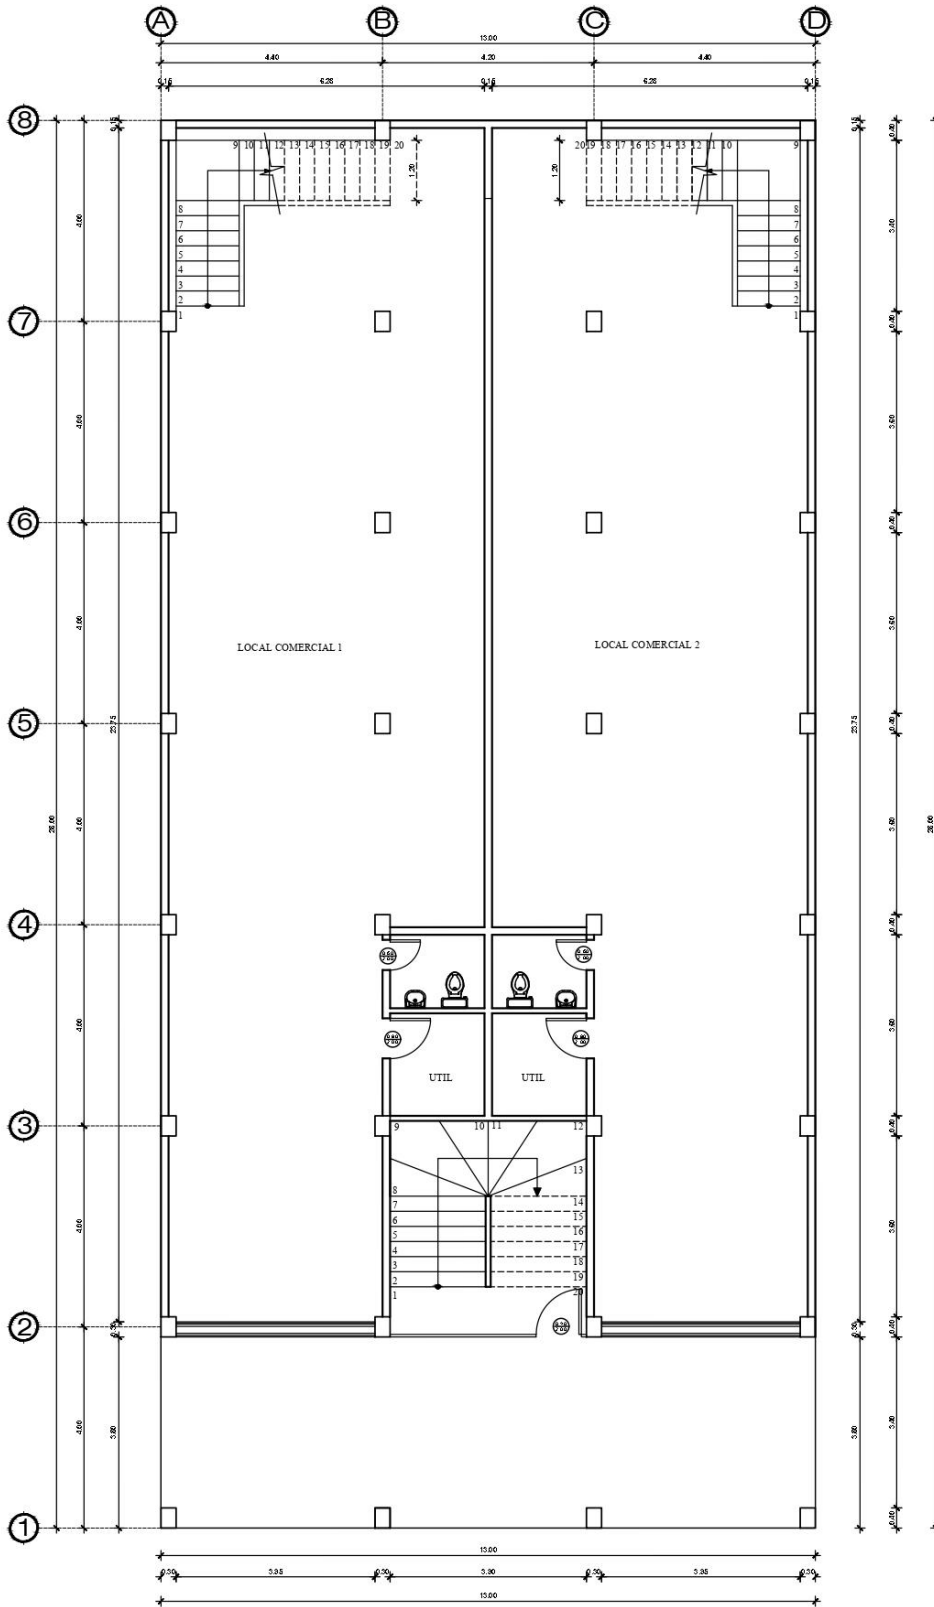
Planta arquitectónica comercio (Autores)
